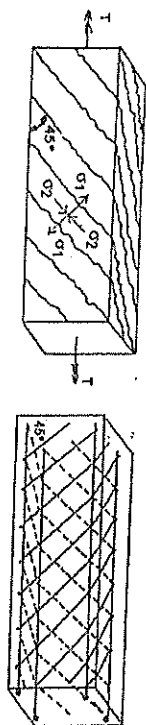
Armadura para torção constituída por barras helicoidais
